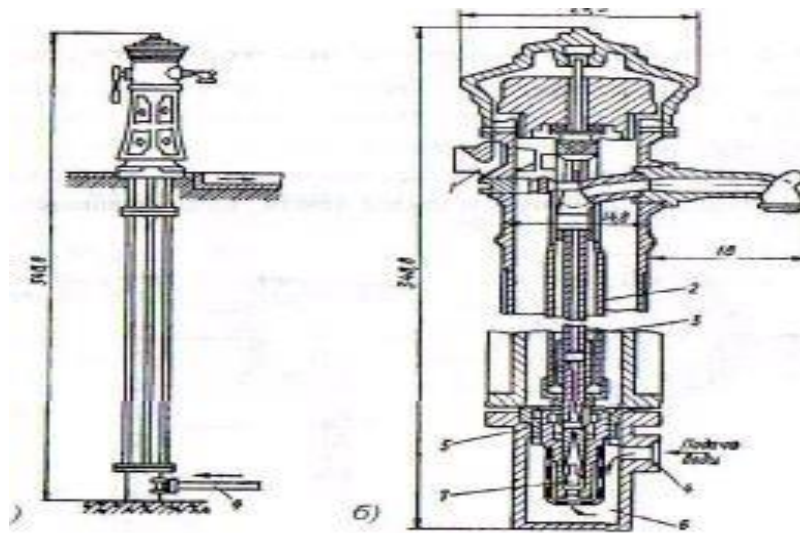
Водорозбірна колонка: а — загальний вигляд; б — деталь верхньої частини; 1 — піднімальний важіль з рукояткою; 2 — трубчаста штанга; 3 — подаюча труба; 4 — патрубок; 5 ежектор; 6 — приймальний бачок; 7 — клапан
